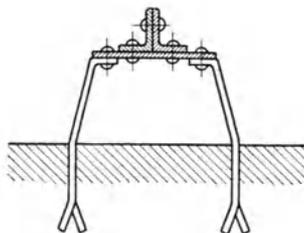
Befestigung eiserner Führungsschienen mit Abstand vom Mauerwerk.
